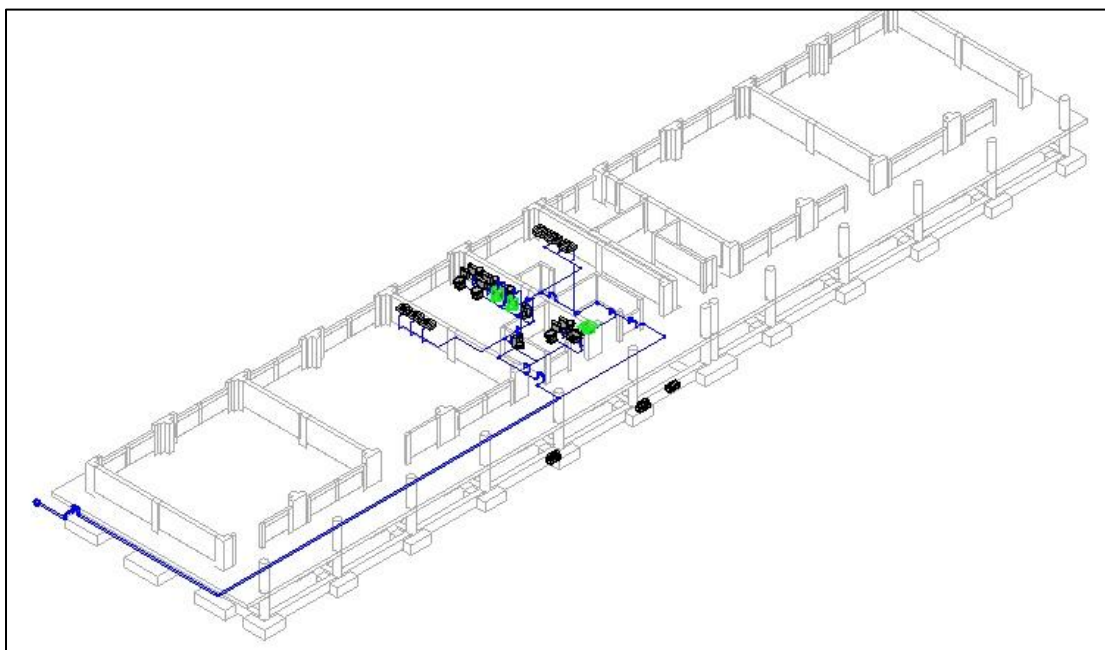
Modelado estructural – zapatas – I.E. N° 56435
